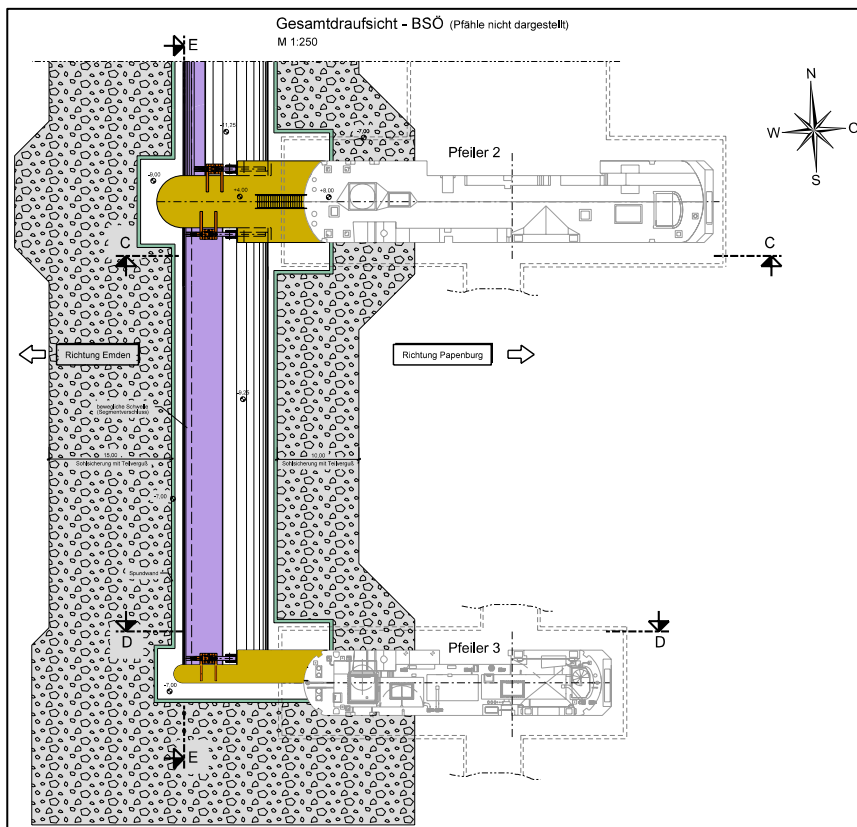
Grundriss, bewegliche Schwelle in Drehsegmentbauweise
